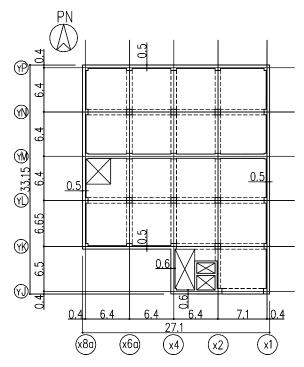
地下1階平面図 (G.L.-4.2) (単位:m)
